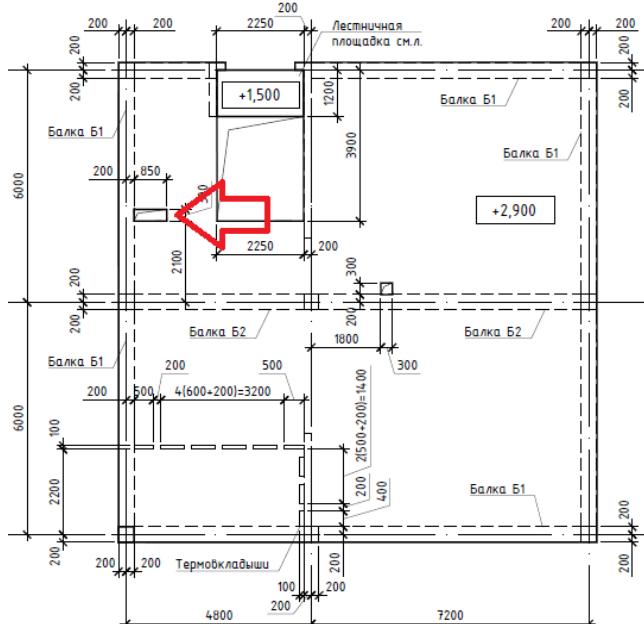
Схема расположения и армирования отверстий через перекрытия.
